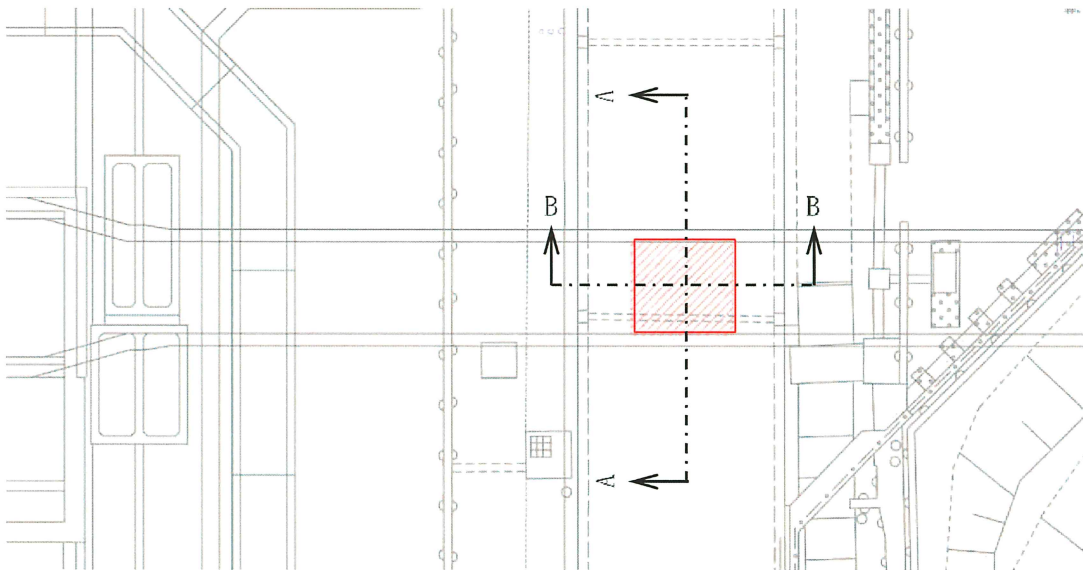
(1) 取放水路流路縮小工（第1号機放水路） 平面図
